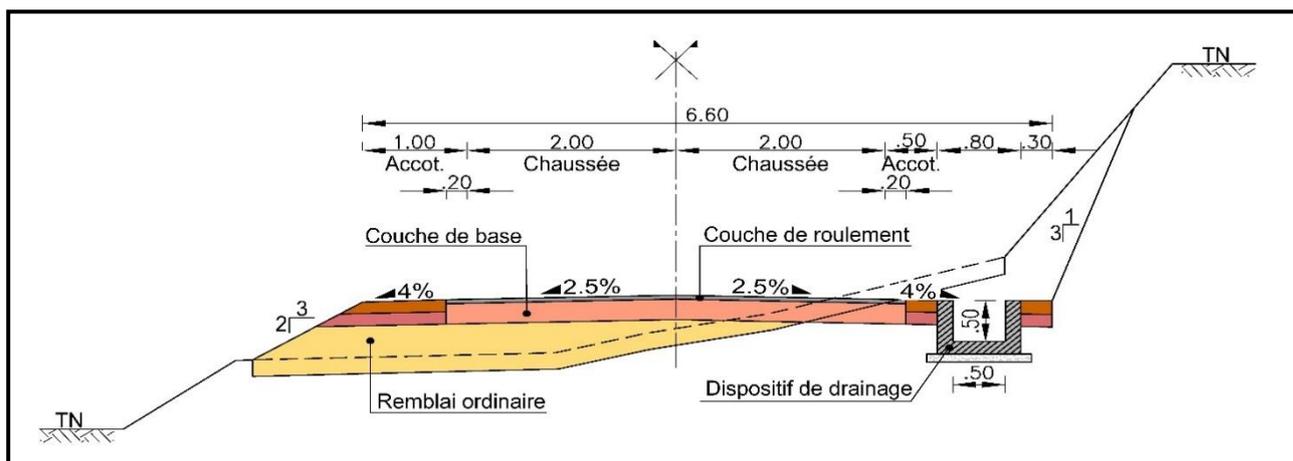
Secção transversal de tipo 2 - Estrada de ligação à ponte de Brigoma
